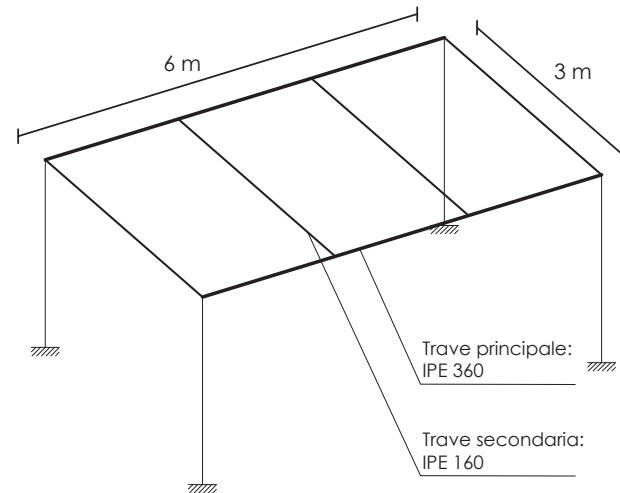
Schema strutturale; Fonte: elaborazione personale;
